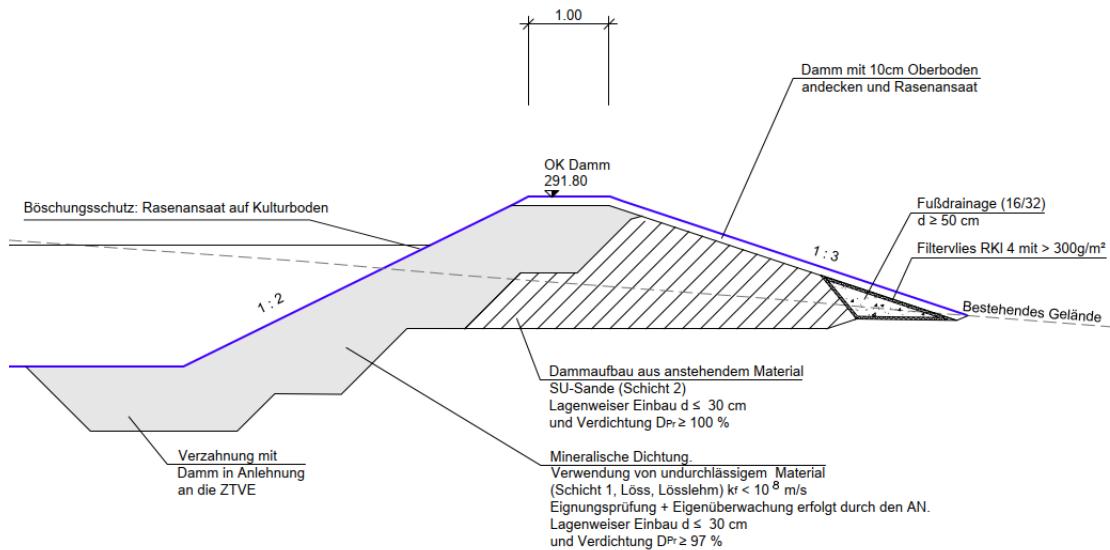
Aufbau nördlicher Damm (vgl. Plan Nr. 04-SEW-DT-005-1)
